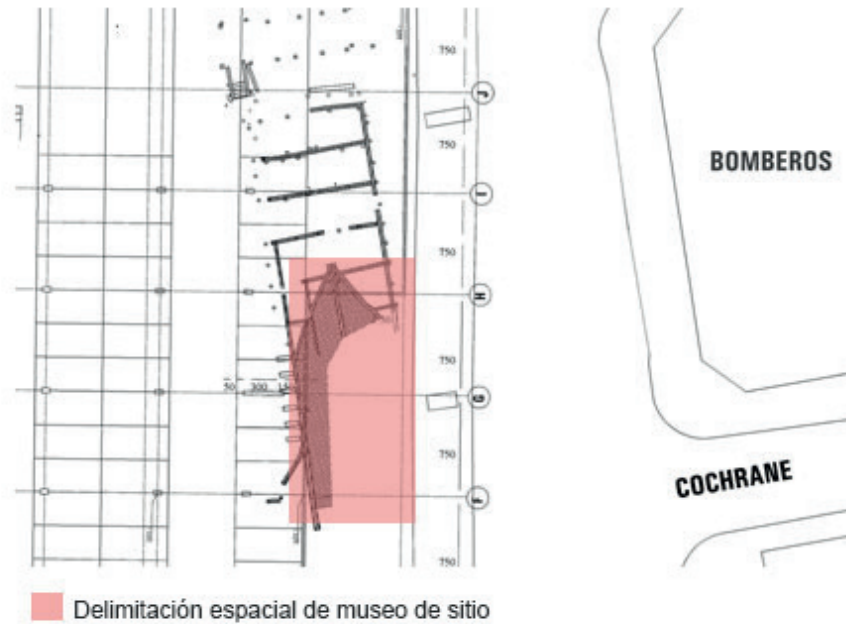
Se aprecia en la planimetría la delimitación espacial del museo de sitio en relación a la totalidad de los hallazgos. Fuente: Elaboración propia a partir de planimetría extraída de Didier/Riveros.
